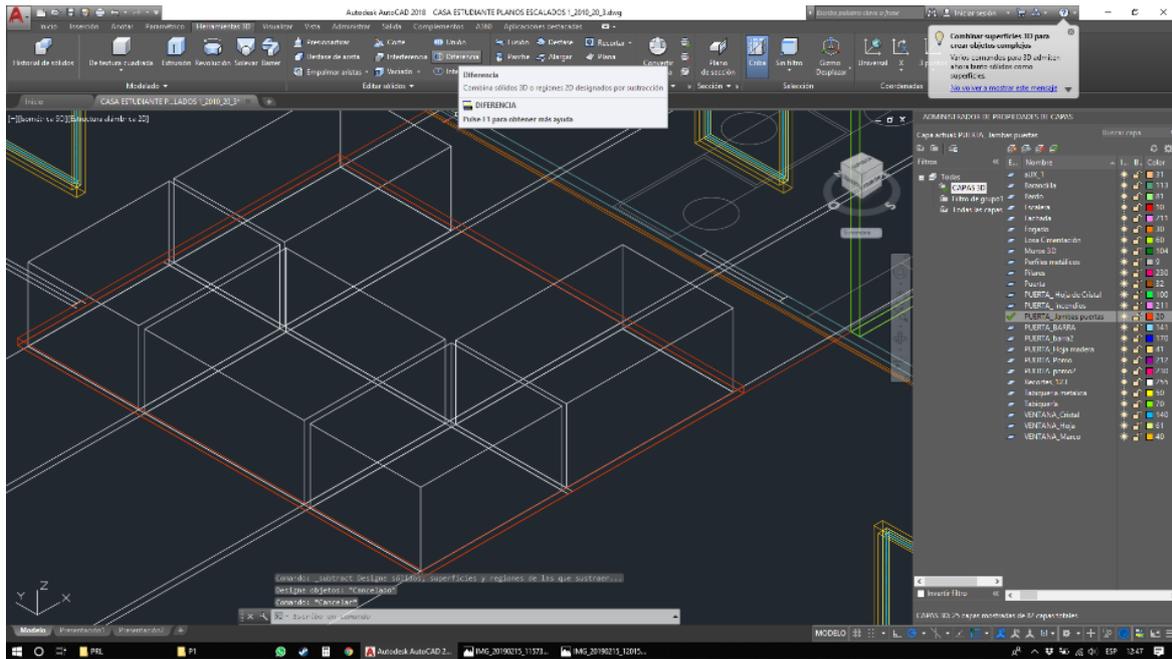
Puerta de cristal despacho 1ª Planta, de 2D a 3D AutoCAD. Casa del Estudiante
